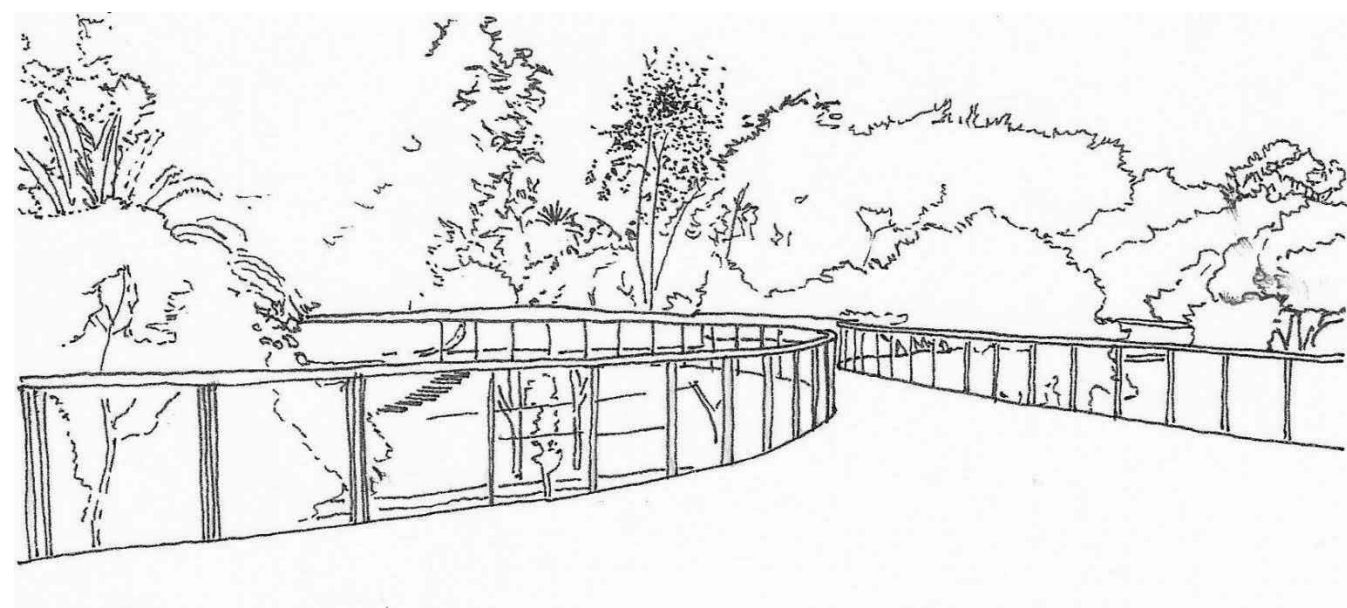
Ponte pedonal da Avenida Artur Ravara, Aveiro
